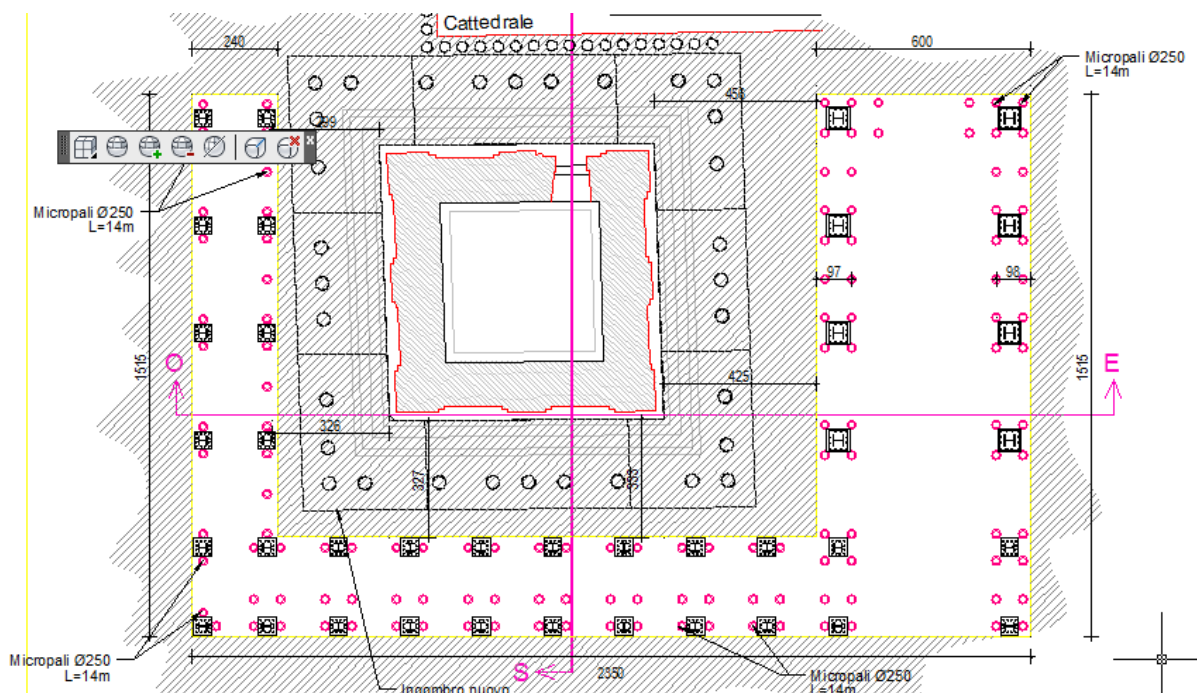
Pianta intervento platea di fondazione della struttura provvisoriale in acciaio su micropali.
